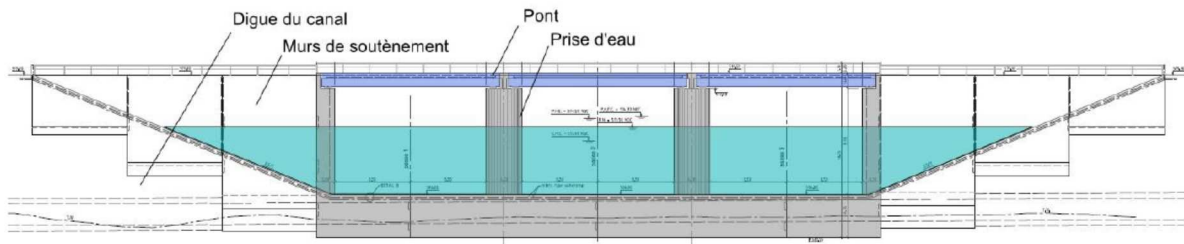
Elévation aval de de la prise d'eau du canal usinier
